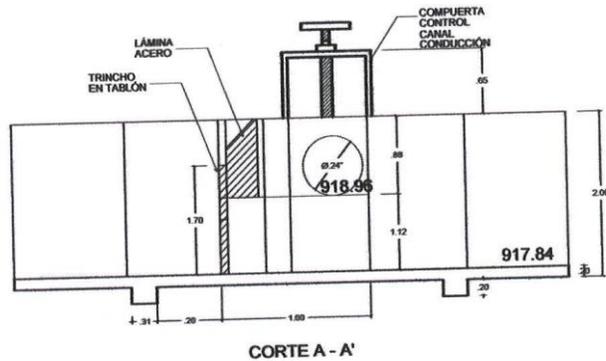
Detalle de la obra de captación, vistas en corte longitudinal.
